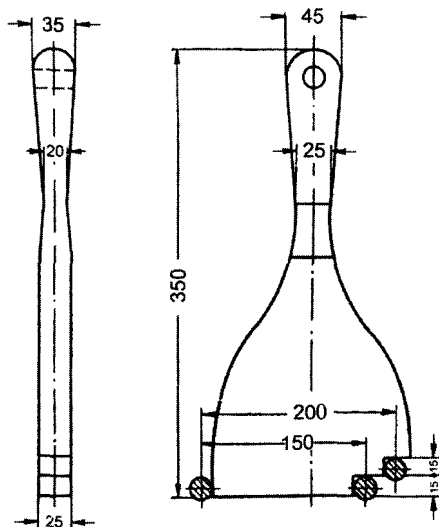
Шаблон для установки горизонтальной и вертикальной арматуры
